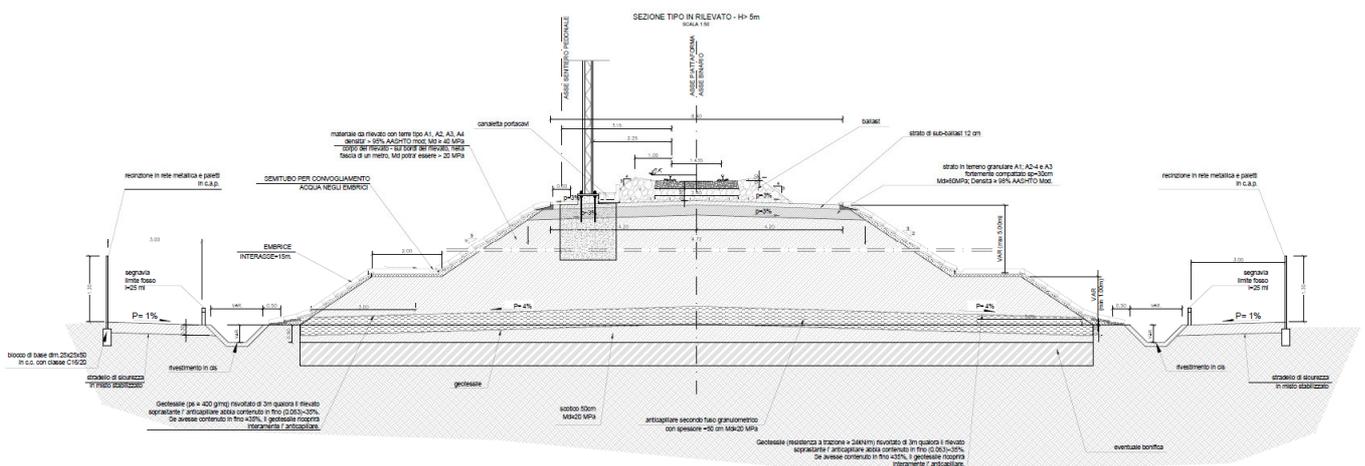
Corpo stradale ferroviario - Sezione tipo in rilevato - altezze > di 5m
